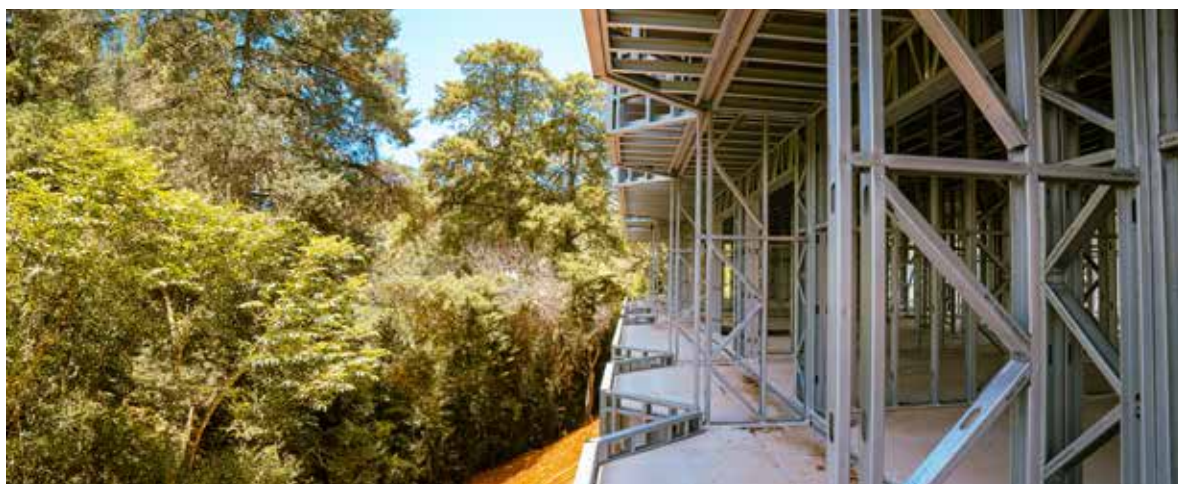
Estrutura em Steel Frame Hotel Serraverde
